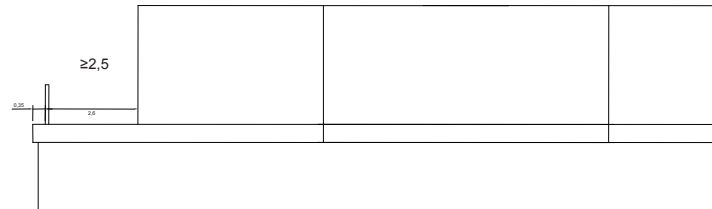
Formación de Cubierta-Terraza, planta-alzado
